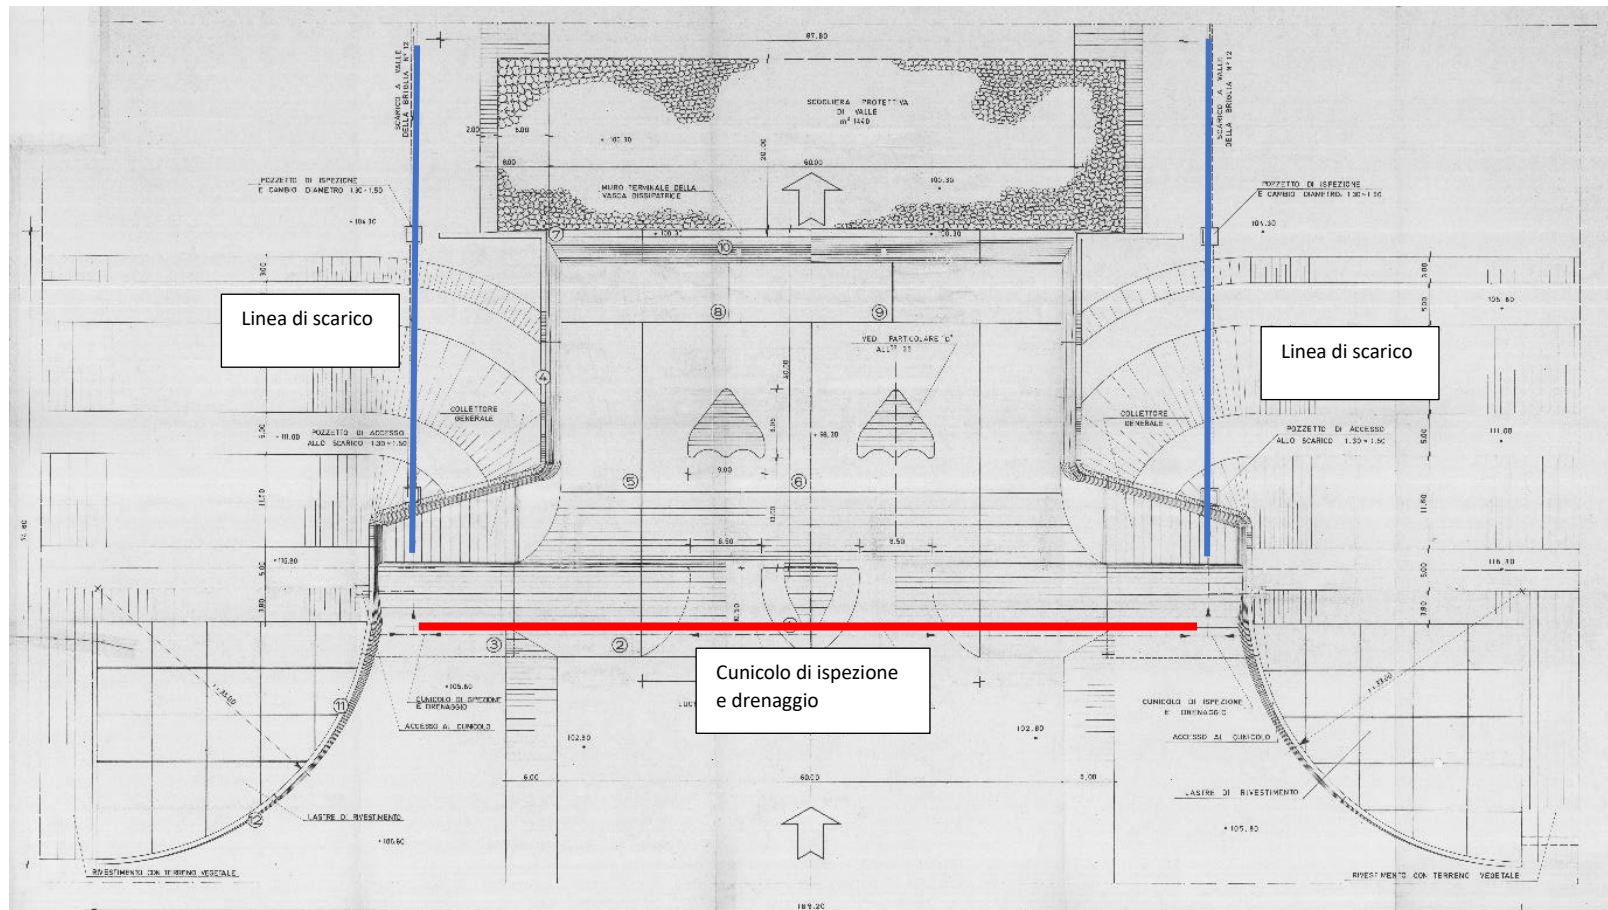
Allegato 21 - Planimetria manufatto con evidenziato il sistema di drenaggio e recapito delle acque
